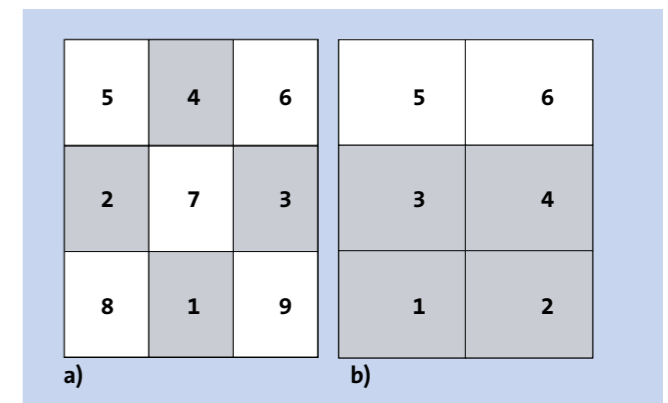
Wahl der Betonierabschnitte bei einer Bodenplatte (Grundriss)
